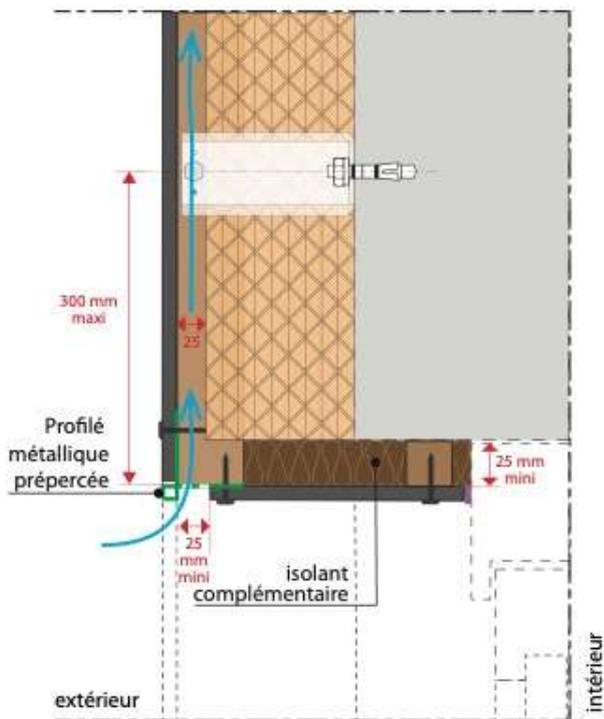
Coupe sur linteau de baie posée a en tunnel au nu intérieur
